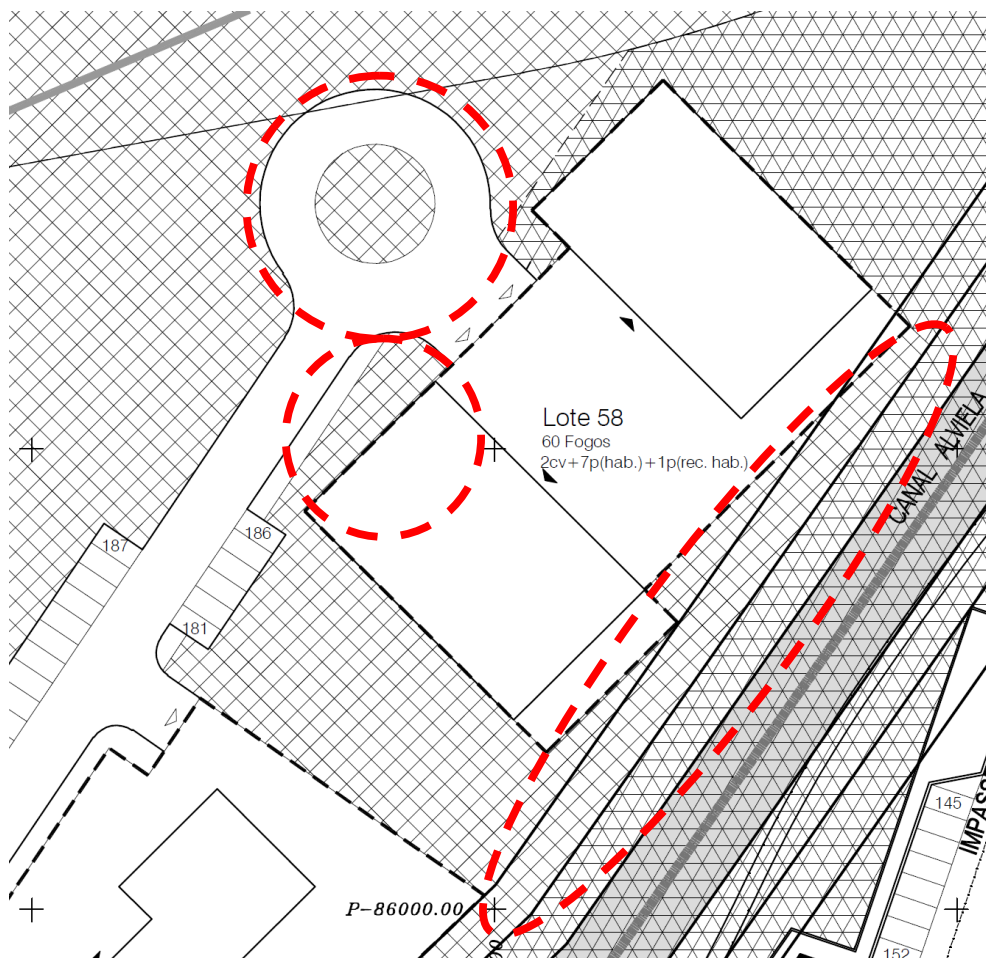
Planta de Síntese Proposta - Telas Finais. Localização de áreas de cedência para equipamentos colectivos propostas em locais residuais. Placa central da rotunda do impasse do arruamento considerada parcela de Equipamento de Utilização Colectiva.
